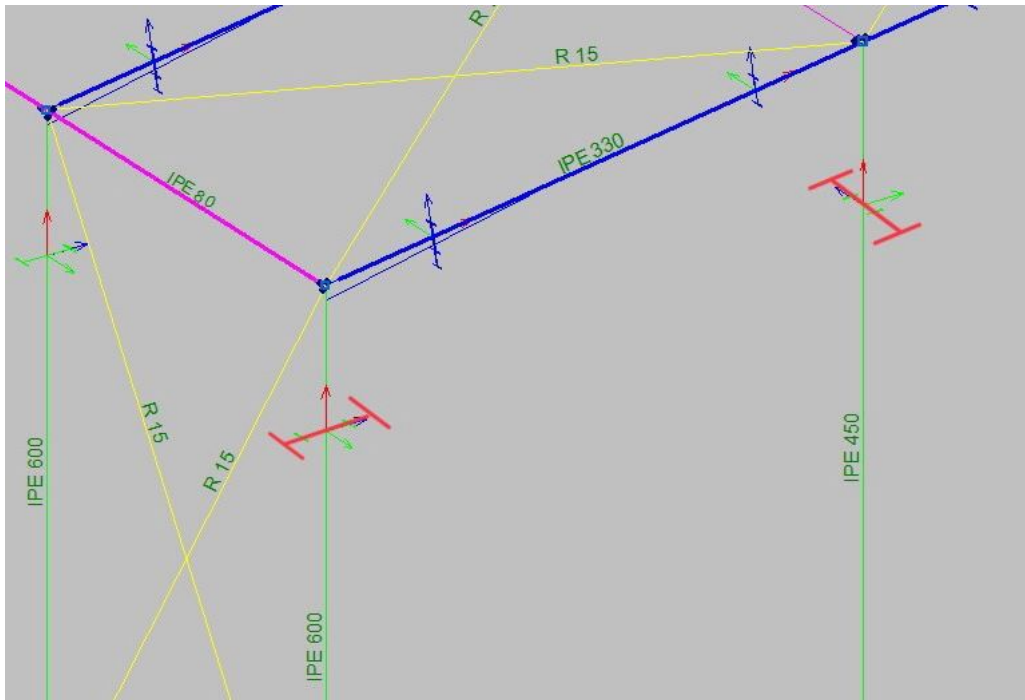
“Detalle orientación de pilares en pórtico hastial. CYPE 3D. Fuente: Propia.”
